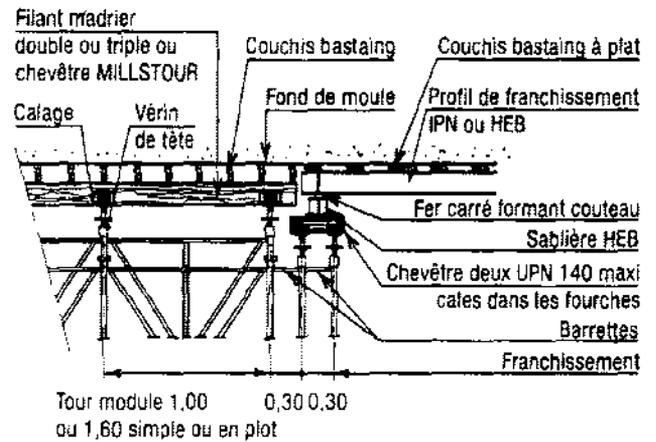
Détail 1 : appui avec poteaux doubles par barrette.
